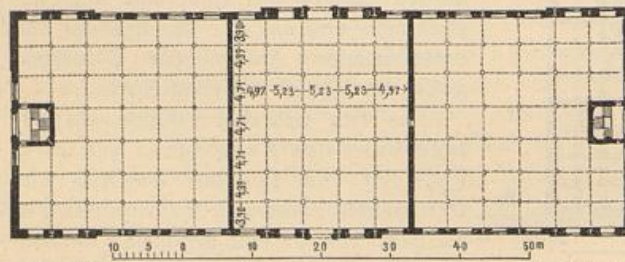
Körnermagazin des Kngl. Proviant-Amtes. (Grundriss.)
